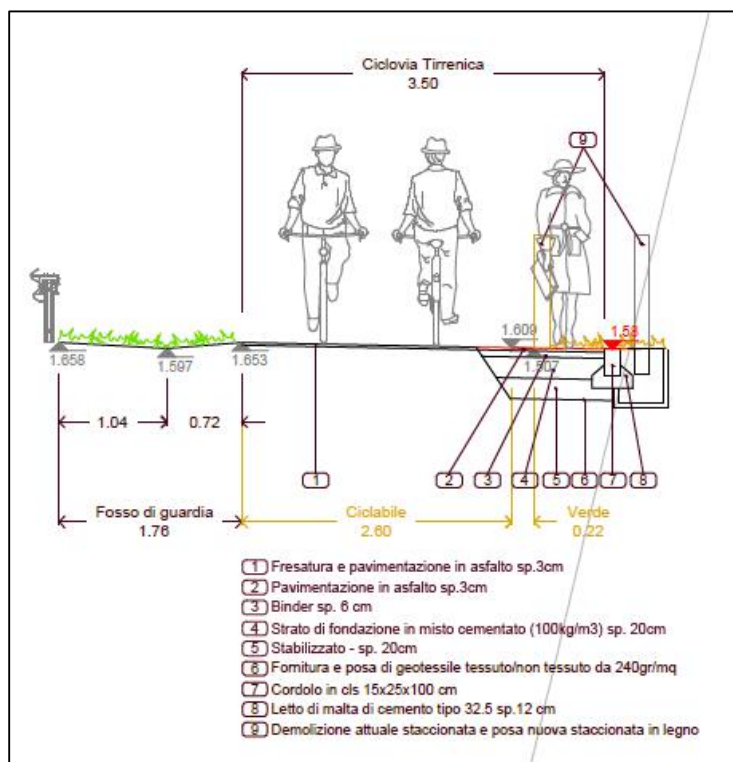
Sezione 18 di progetto trasversale SP delle Collacchie
